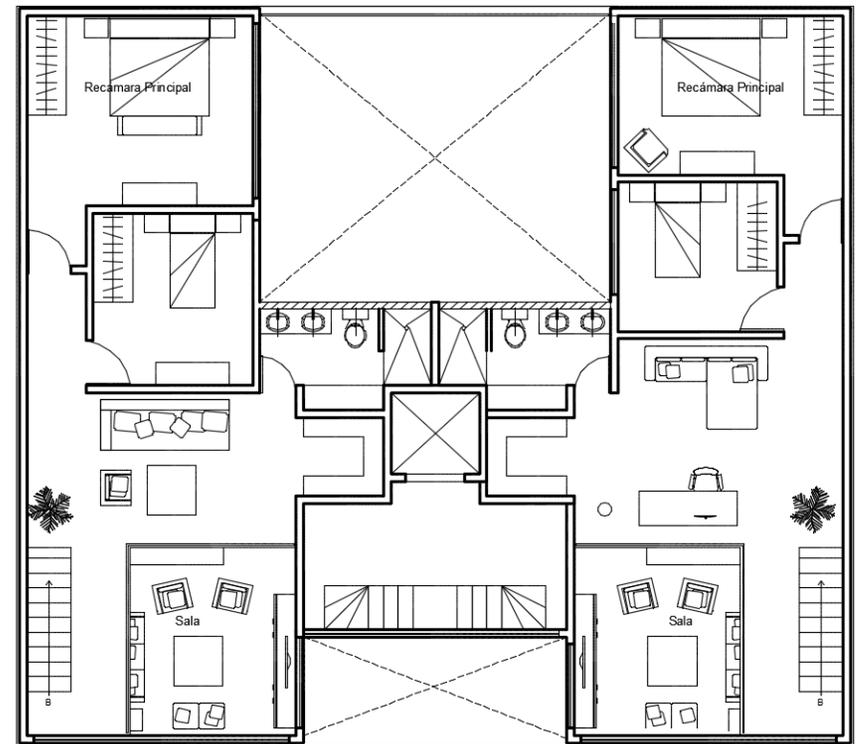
Planta tipo D Penthouse planta alta, cuarta hipótesis
